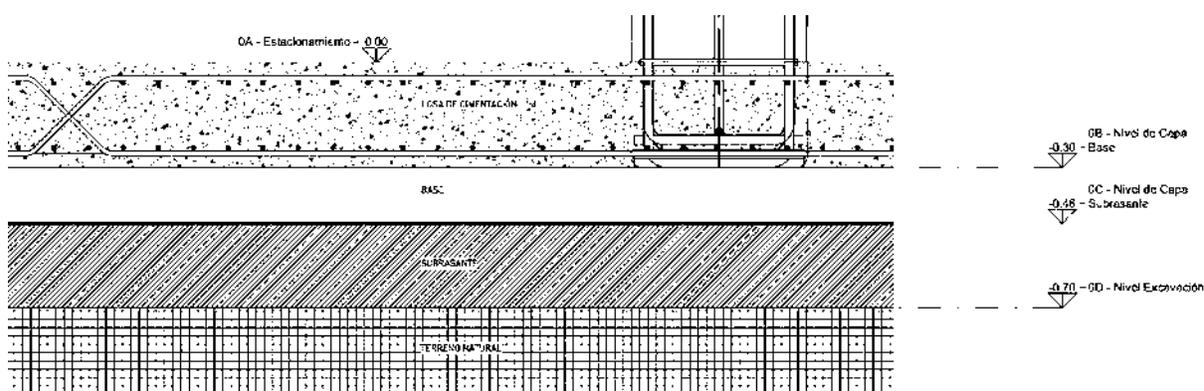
Vista en corte del proceso de capas para el mejoramiento del terreno, así como un detalle del armado de la losa de cimentación.
